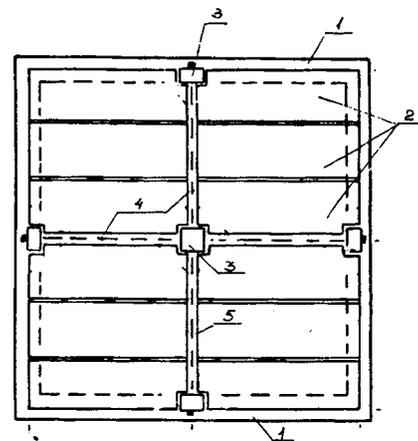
Перекрытия бескаркасной системы, состоящие из мелкоштучных плитных элементов из разных видов бетона (тяжелый, легкий, ячеистый)
